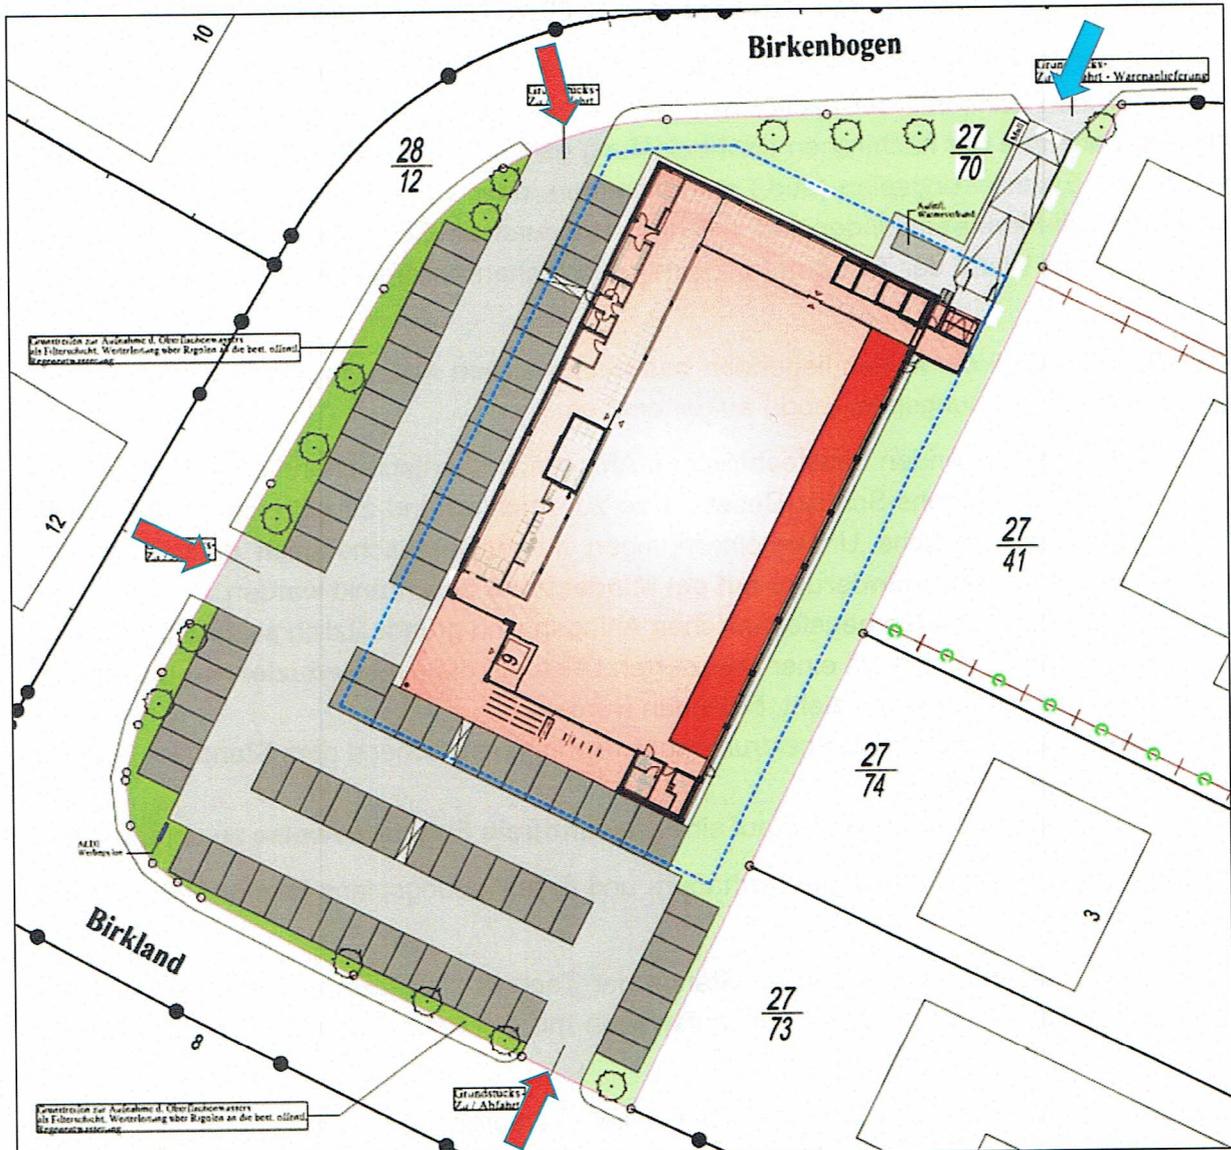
Vorhaben- und Erschließungsplan, eingezeichnet sind die Zu- und Abfahrten für den Kundenverkehr (rote Pfeile) sowie die Zufahrt für die Anlieferung (blauer Pfeil), Quelle des Lageplans: Architekturbüro Matzen, ohne Maßstab
